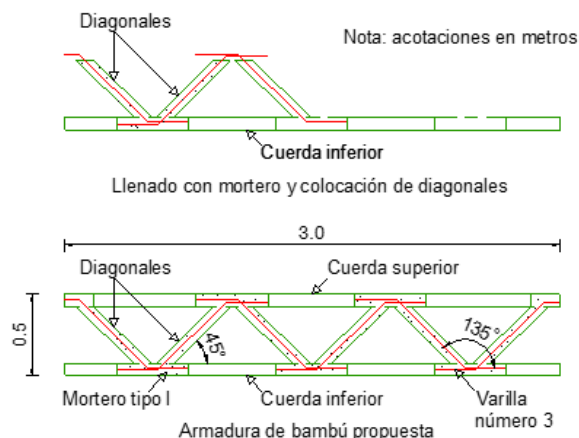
Geometría y detalles de armadura de bambú tipo Warren (continuación)
